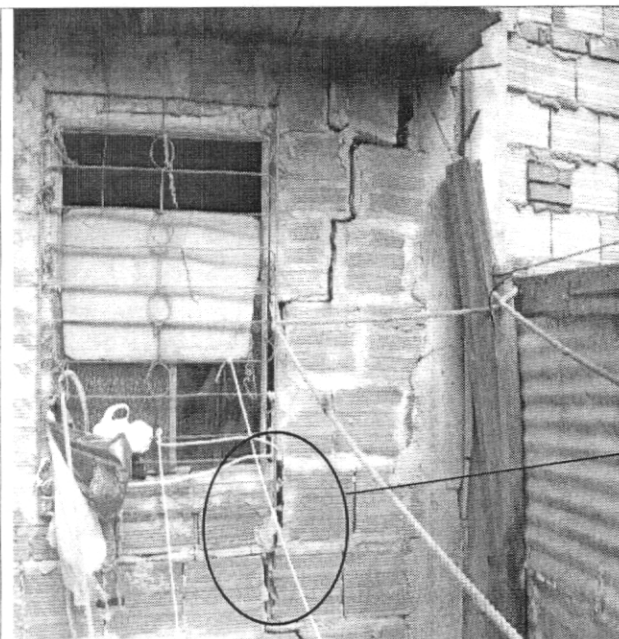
Parte posterior de la vivienda. Detalle de grieta en el muro en la parte superior, y rompimiento de vidrio debido al asentamiento
